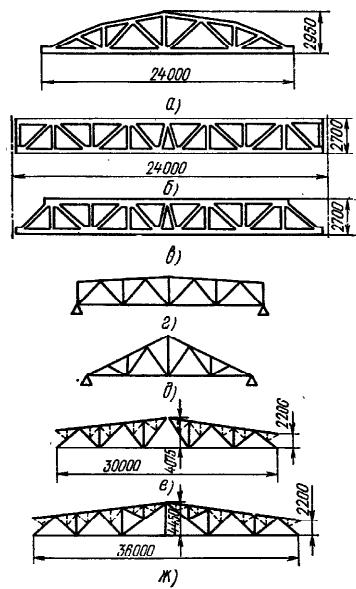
Железобетонные (а—е) и металлические (ж—ж) фермы:
